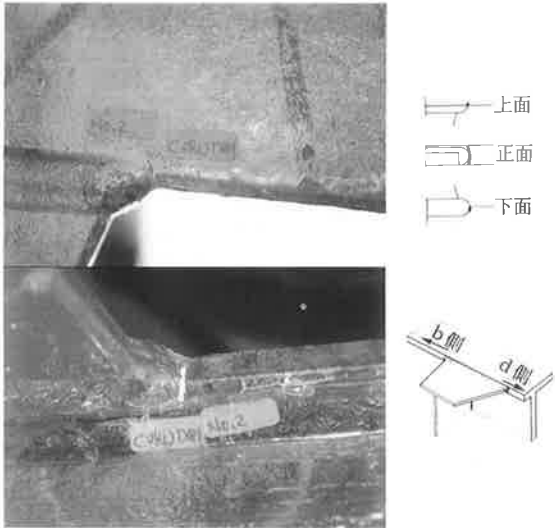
まわし溶接部の割れ (a-タイプ)
